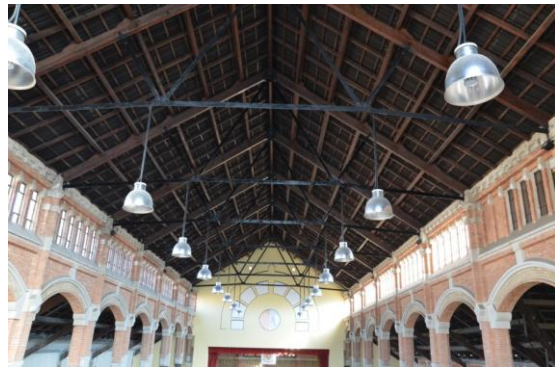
Vista de la cubierta de la nave principal, desde el interior.
